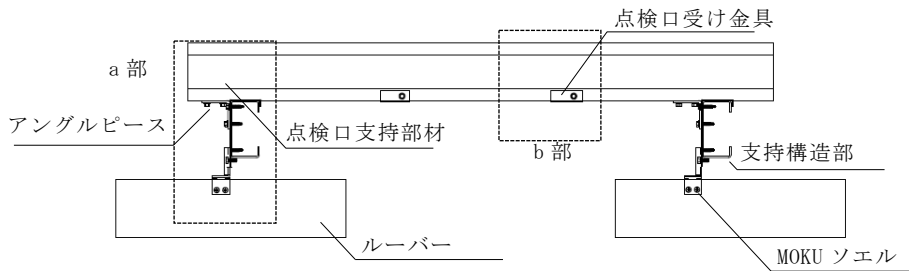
点検口支持部材の設置 A-A' 断面図
